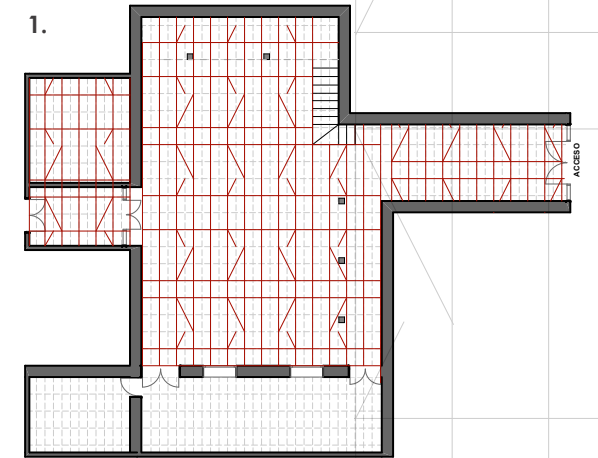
Colocación de la malla en planta. Fuente: Elaboración Propia
